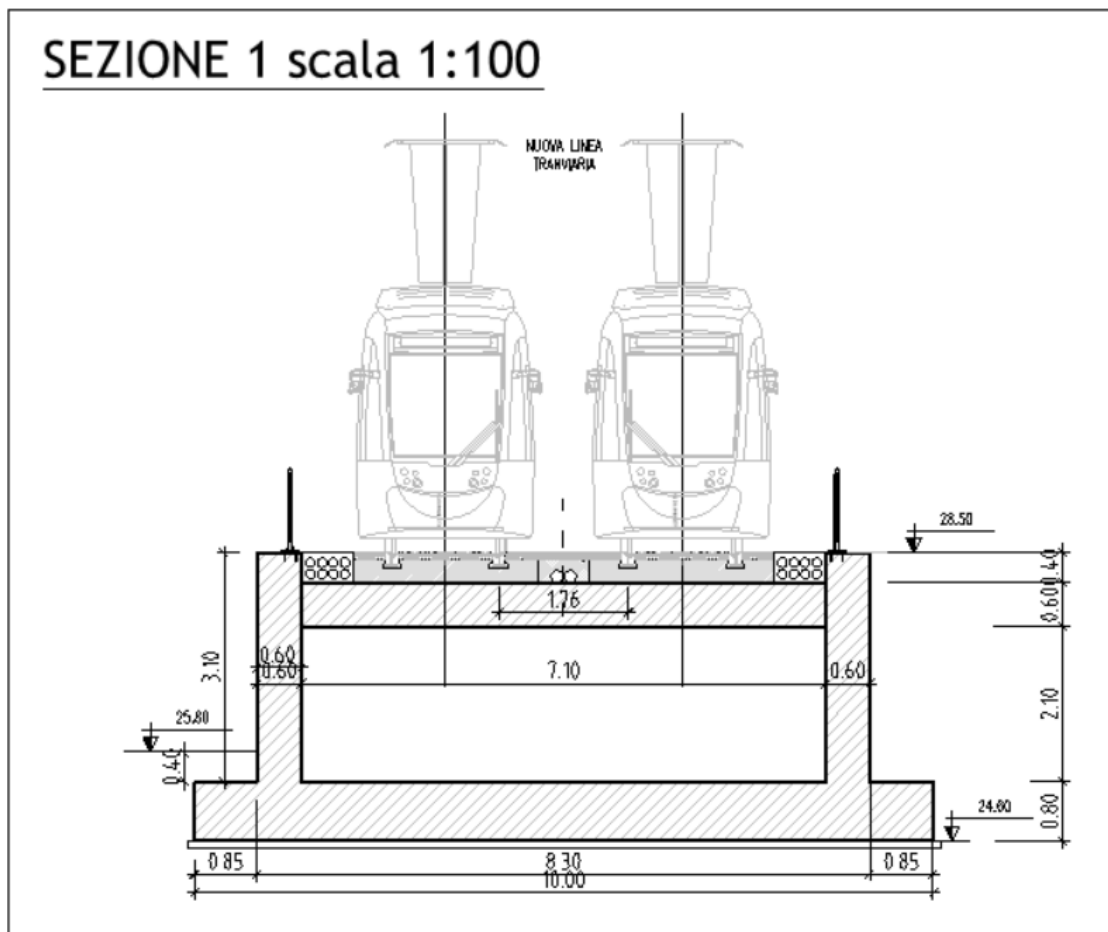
Sezione trasversale 1-1 primo tratto
